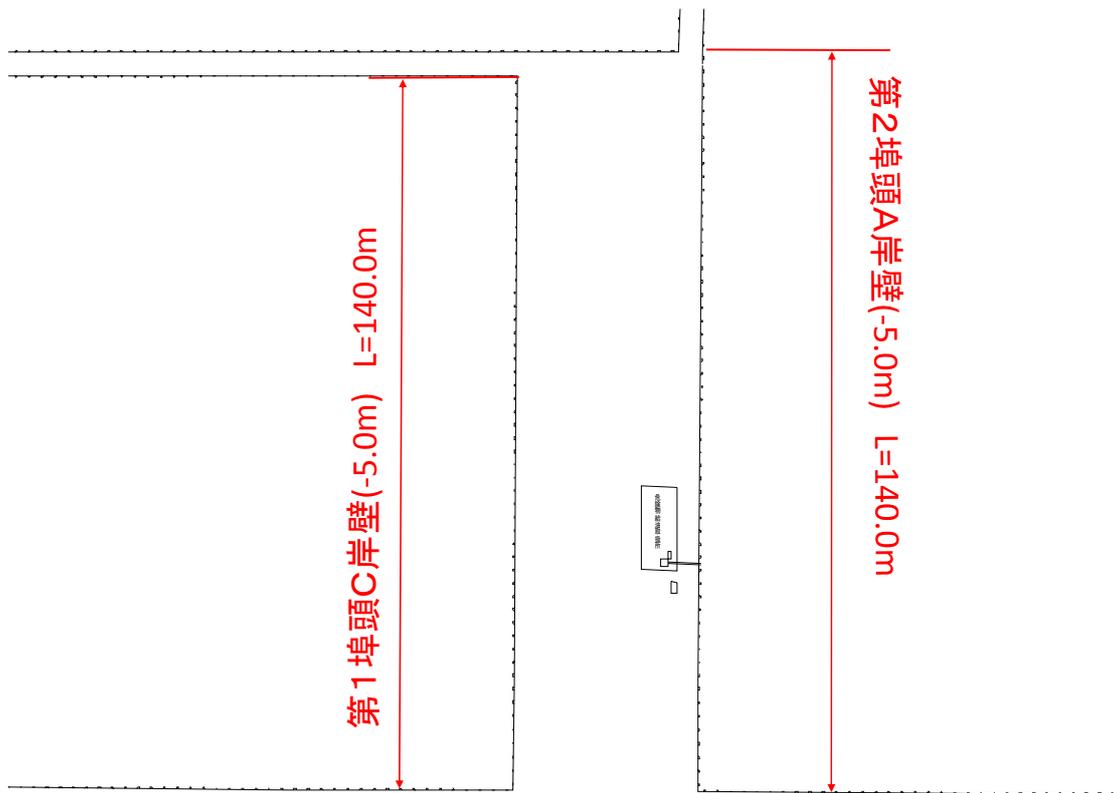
No.30 大洗港区_第2埠頭 A 岸壁 (-5.0m) (中央地区) の平面図 (被災前)
